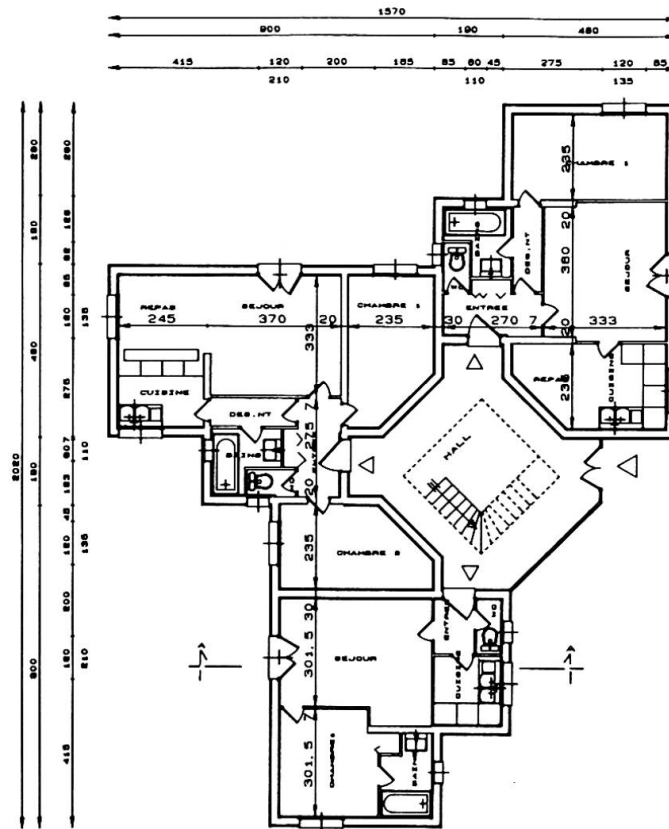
ARCADE – Vue en plan – Sortie sur traceur
